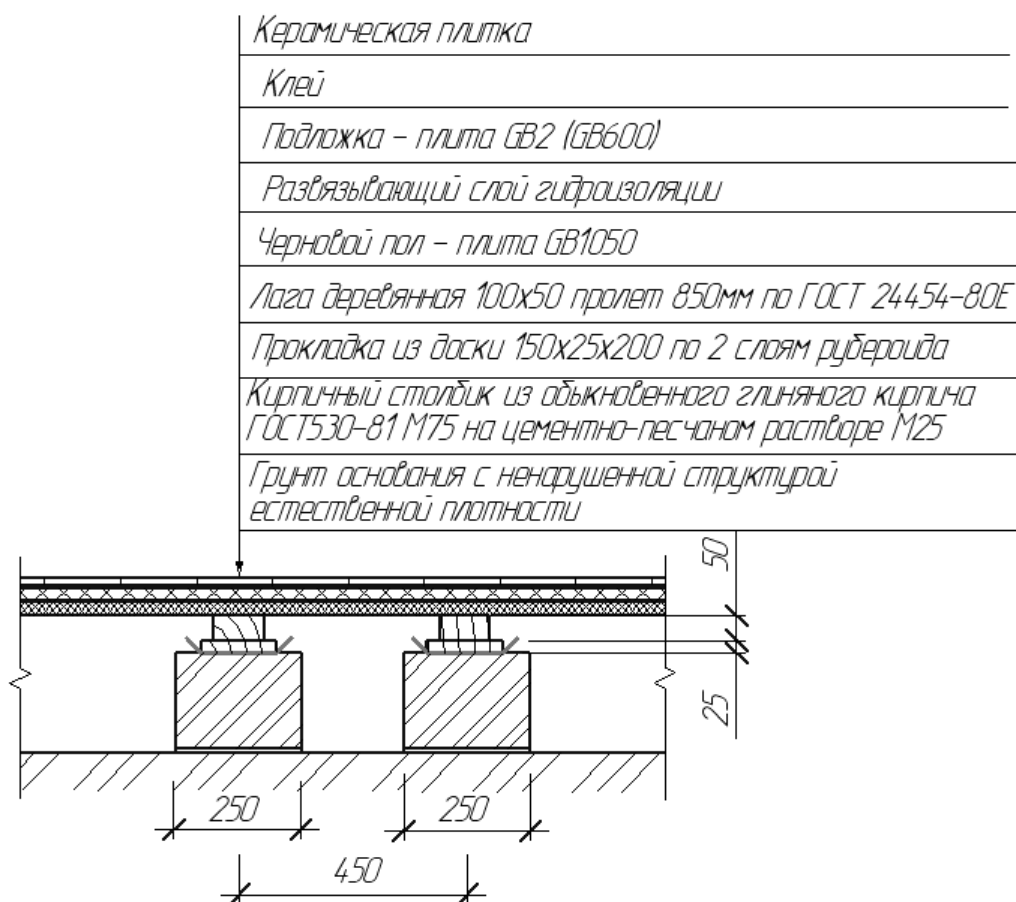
Конструкция плиточного пола по грунту с применением плит системы плит GREEN BOARD® без утепления с покрытием на деревянных лагах
